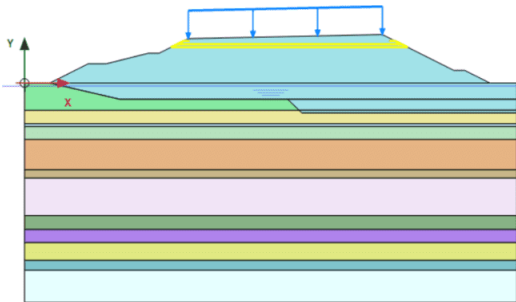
Pemodelan timbunan dengan *soil replacement* 3 m dan 4 lapis geotekstil
